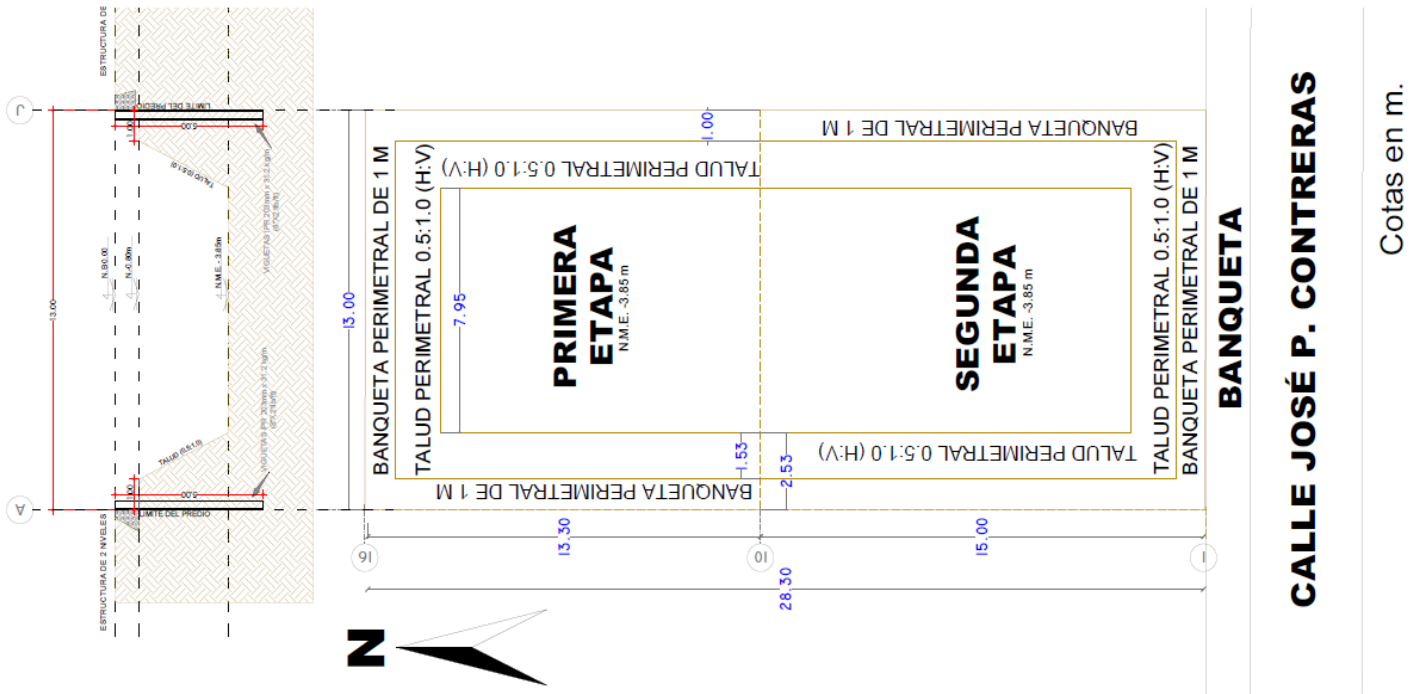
PROYECCIÓN EN PLANTA Y SECCIÓN TRANSVERSAL DE LA EXCAVACIÓN
